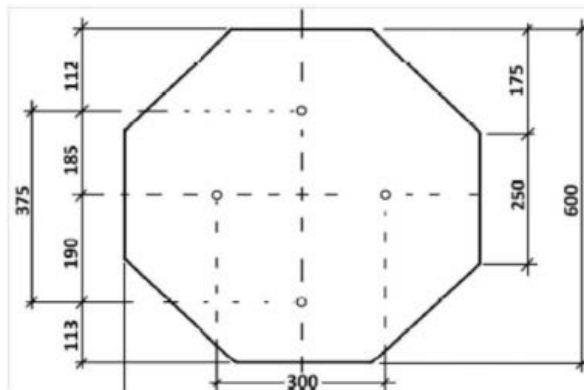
Detalhe do Dispositivo Anti-Giro e da Fundação
